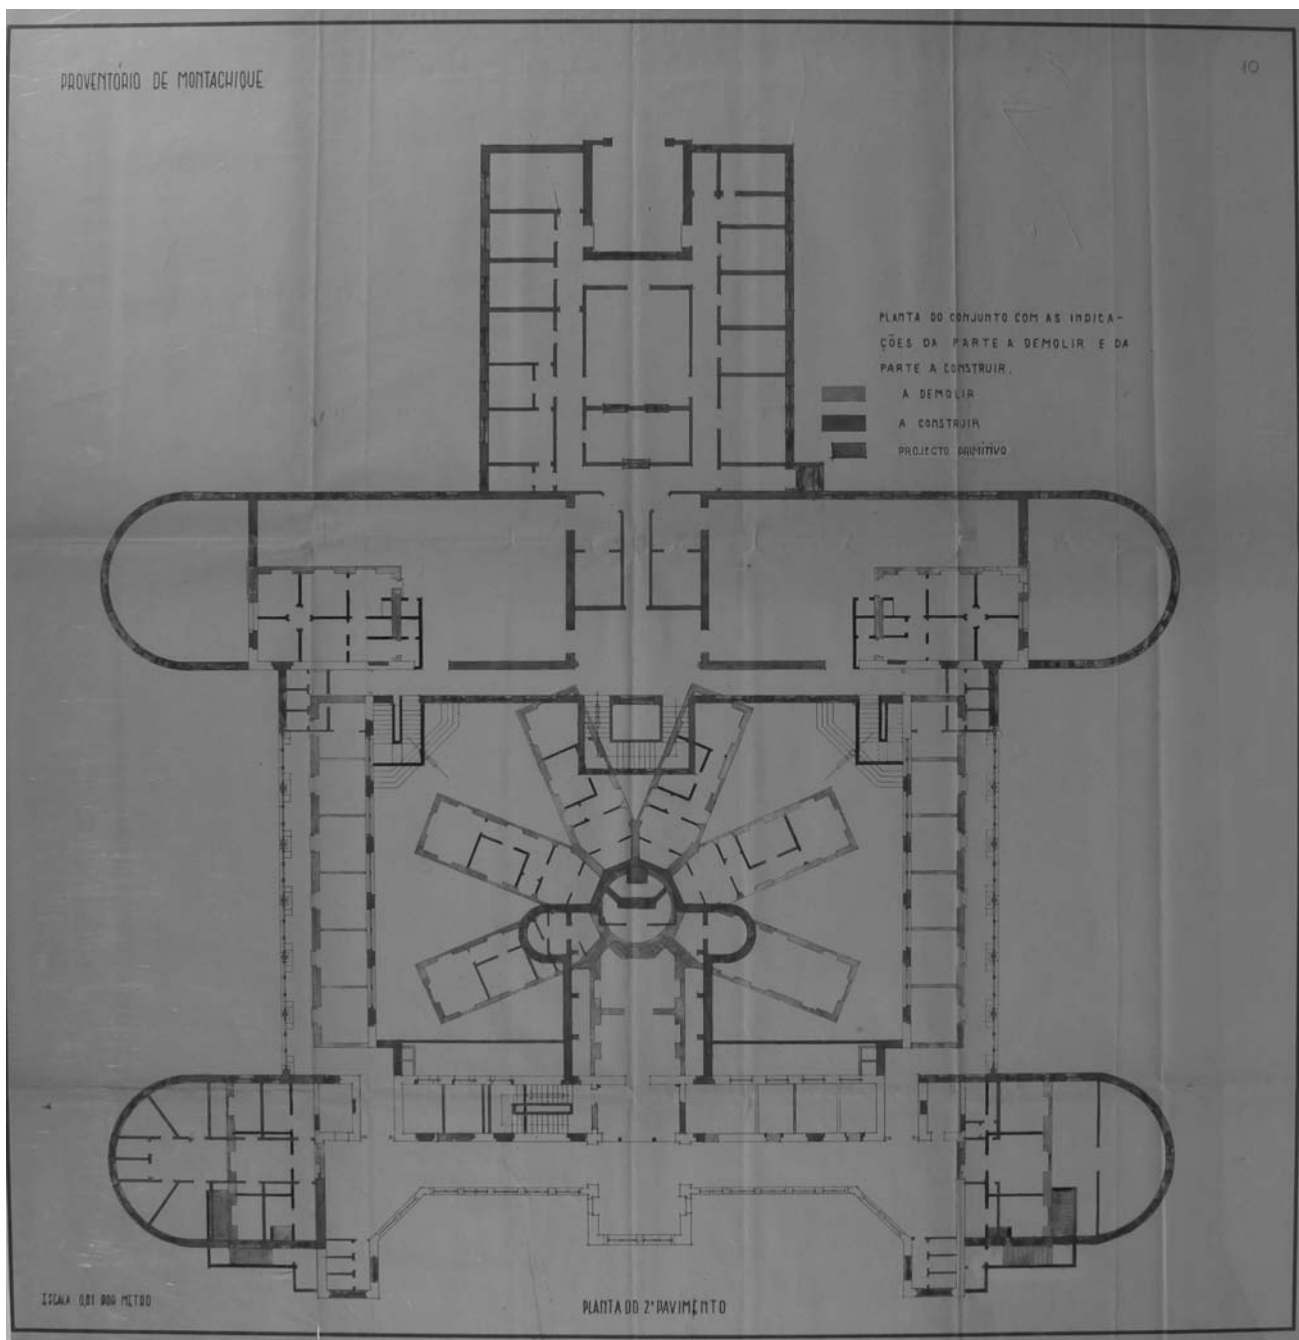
Sanatorio Albergaria de Montachique - planta com as alterações (a demolir, construir e projecto primitivo) - Planta do 2.º Pavimento. SIPA: DES\_847854.
